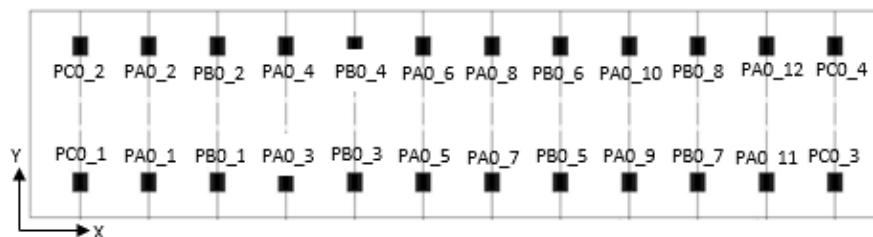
Disposição dos pilares em planta. (Adaptado de: [40])
